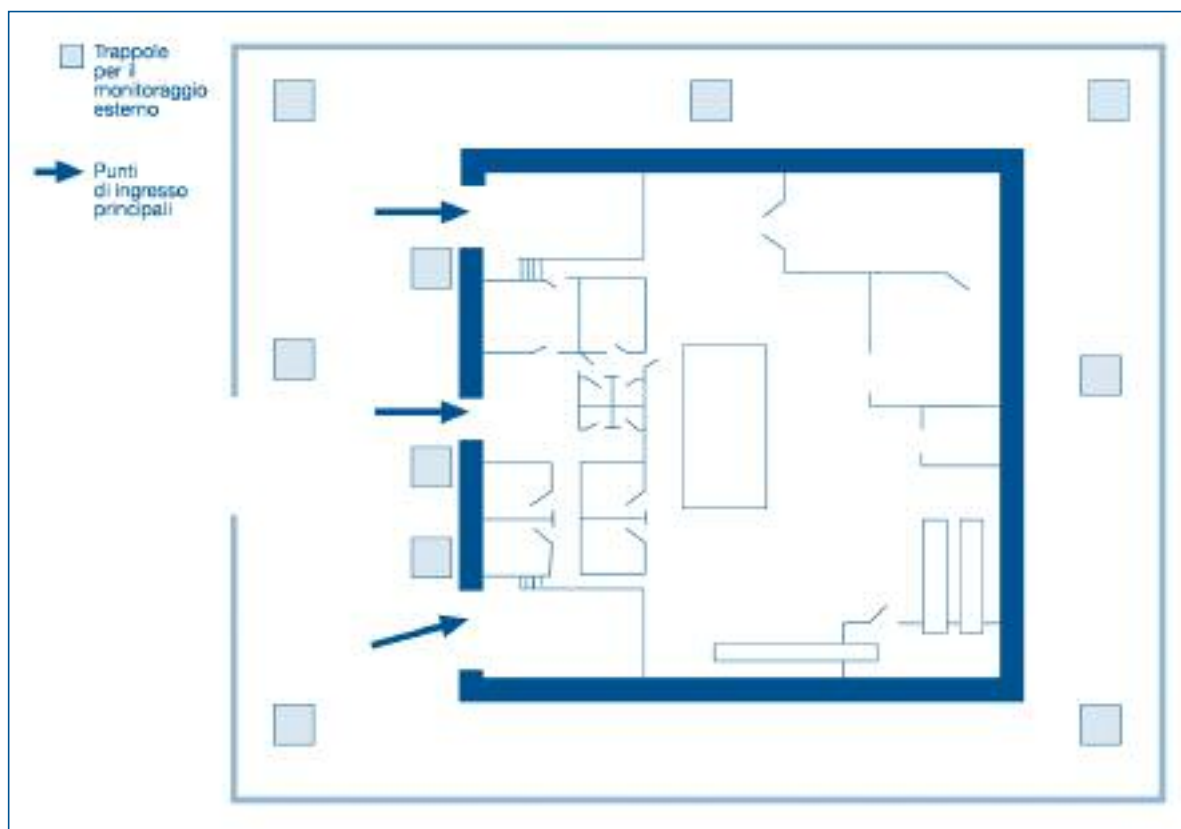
Planimetria dell'azienda, indicazione degli ingressi principali e collocazione delle trappole
